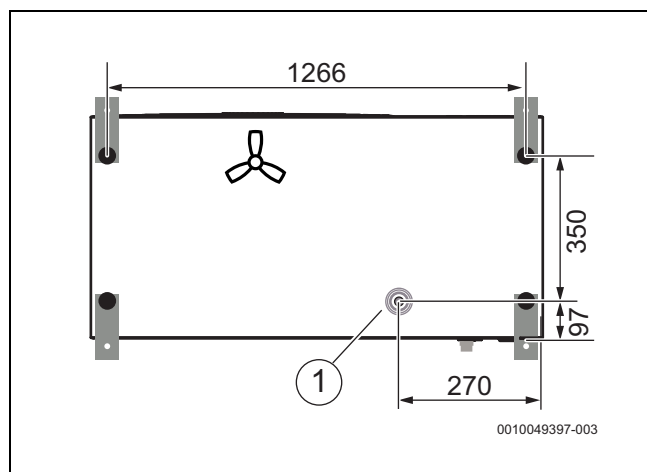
Dimensioni della pompa di calore, lato inferiore
